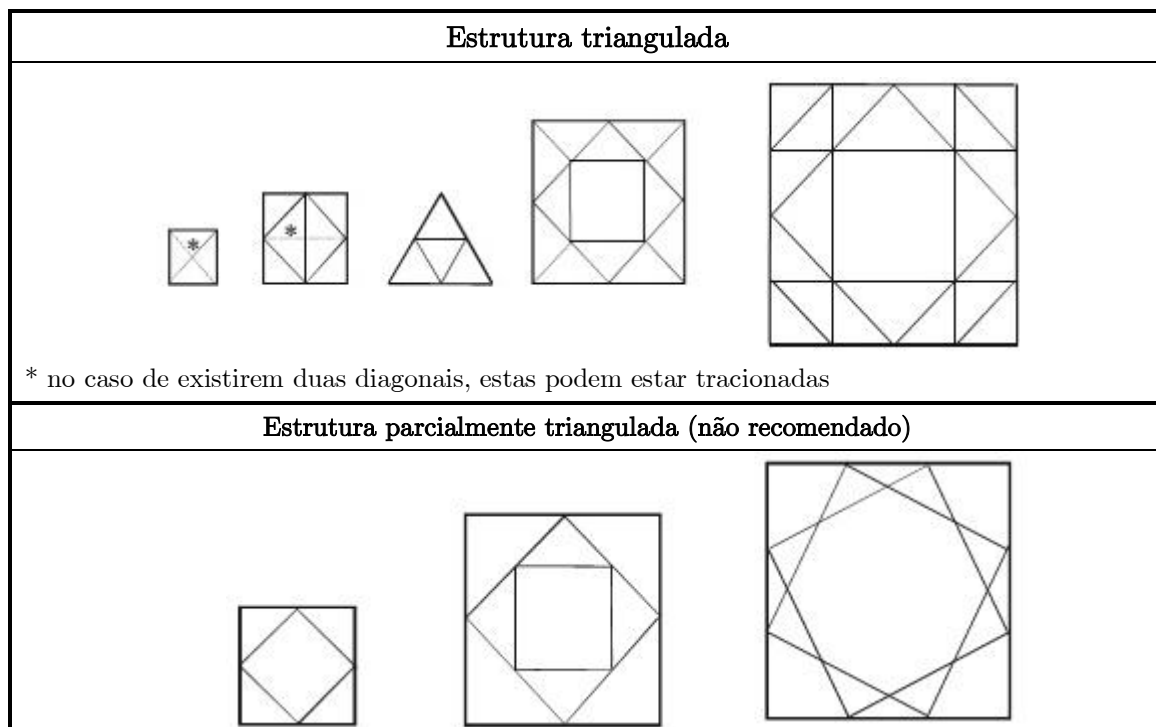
Vista superior de configuração típica de contraventamento horizontal (Fonte: Adaptação - EC3 3-1)
